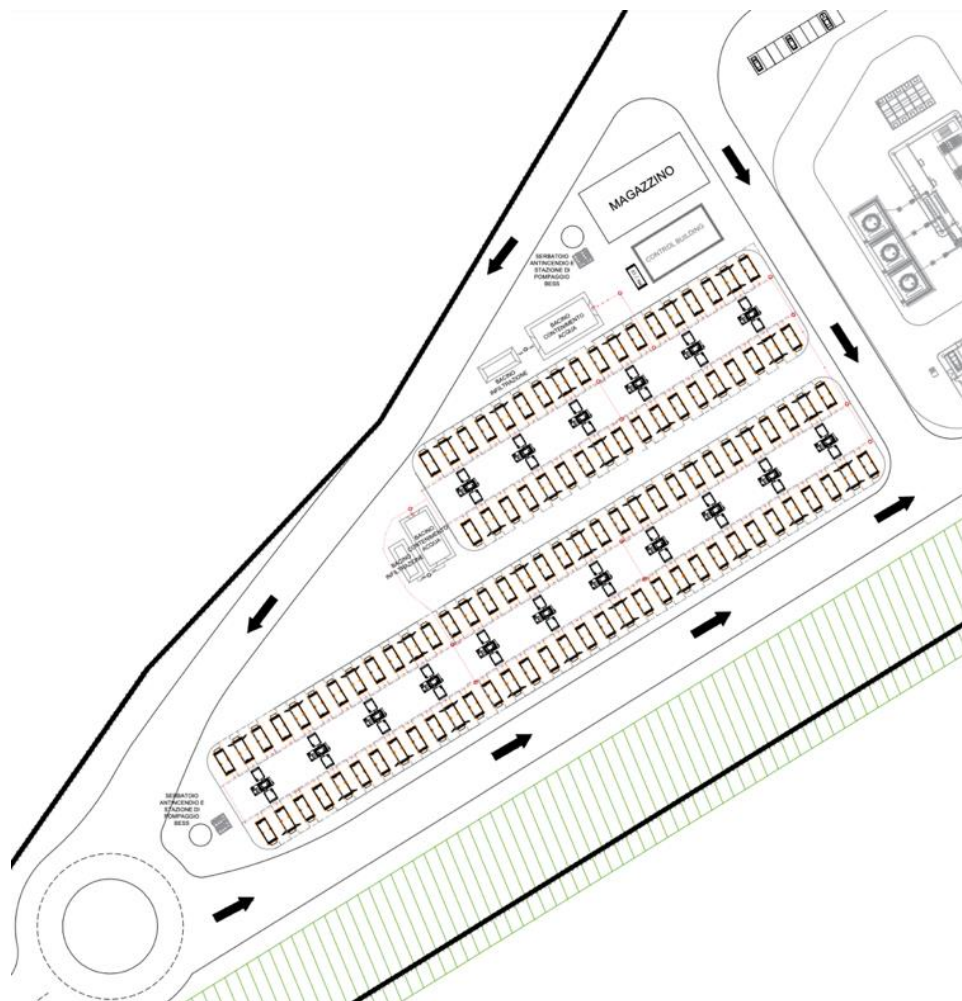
Planimetria impianto di stoccaggio energia (BESS)
